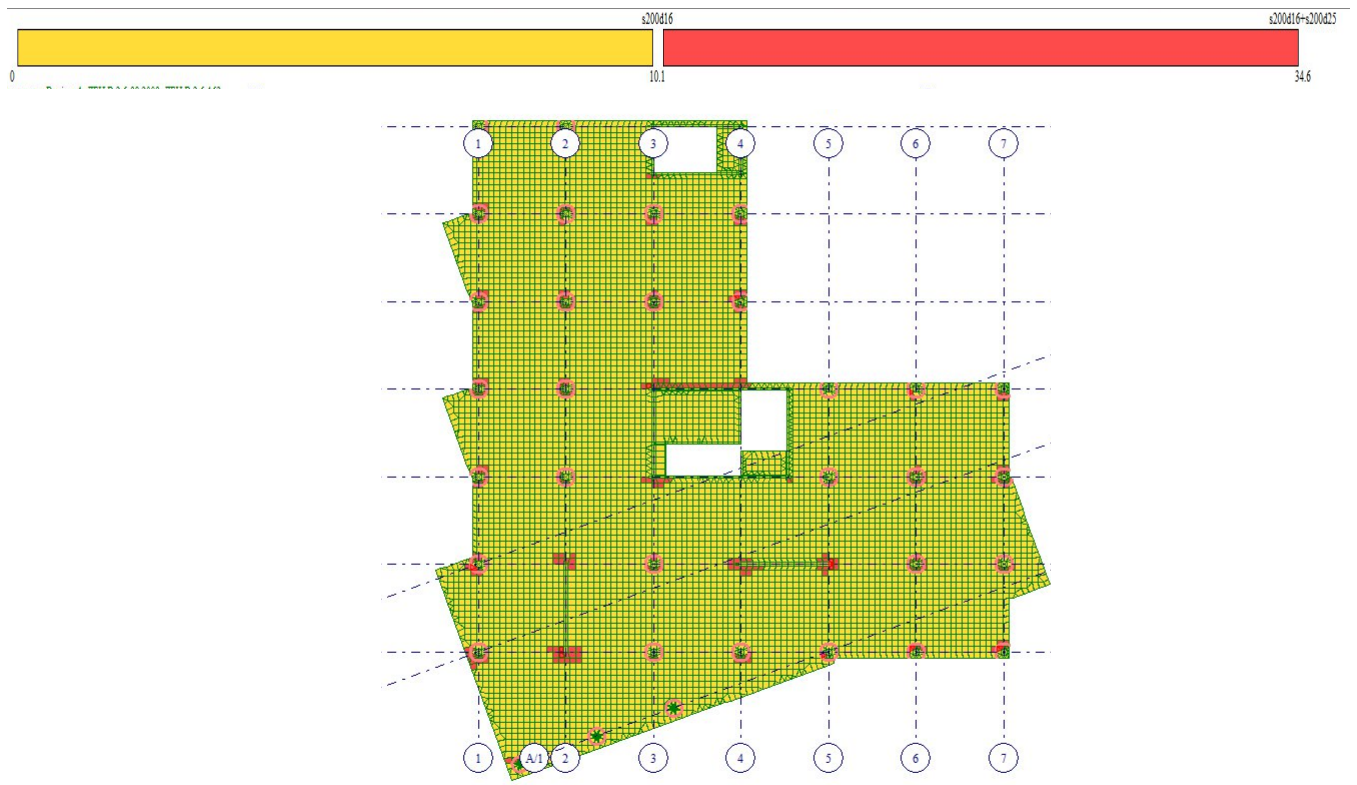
Верхнє армування плити перекриття в ПК Ліра САПР
